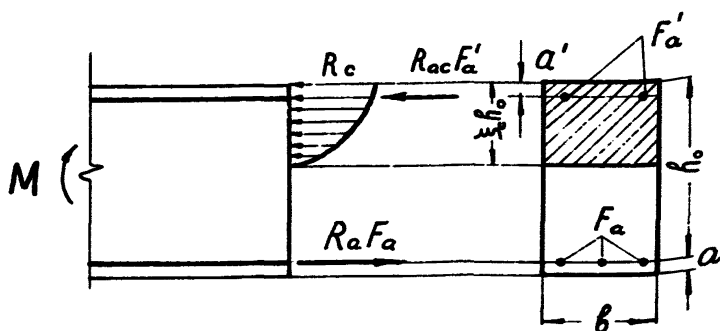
Схема расположения усилий в поперечном сечении изгибаемого сталеполимербетонного элемента с двойной арматурой при расчете его по прочности.
